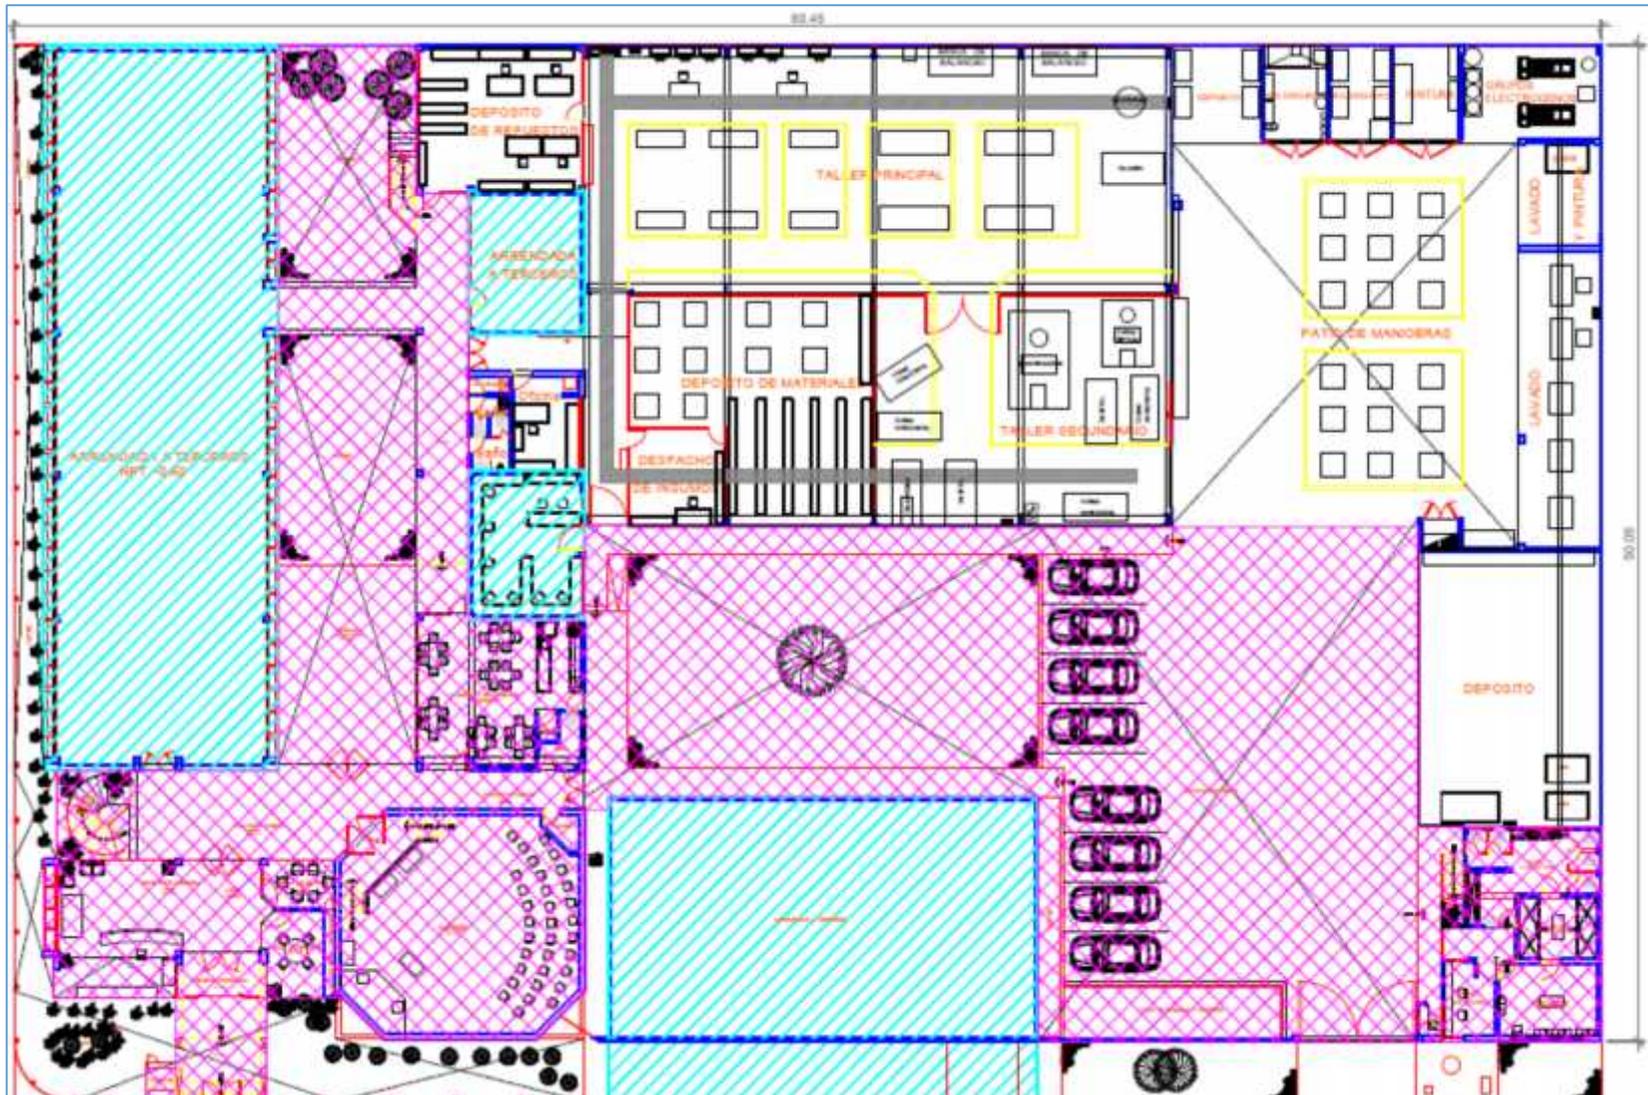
Plano de Distribución del Primer Piso Alfa Laval
